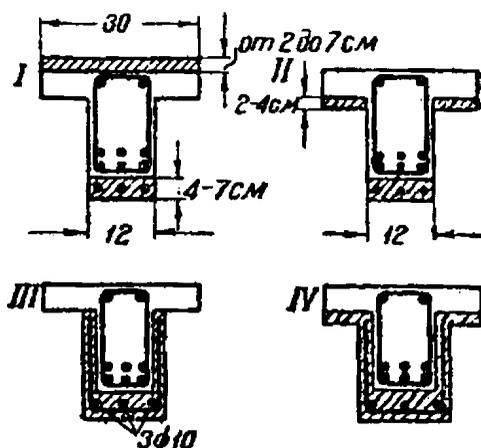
Усиление железобетонных балок по методу Метростроя
